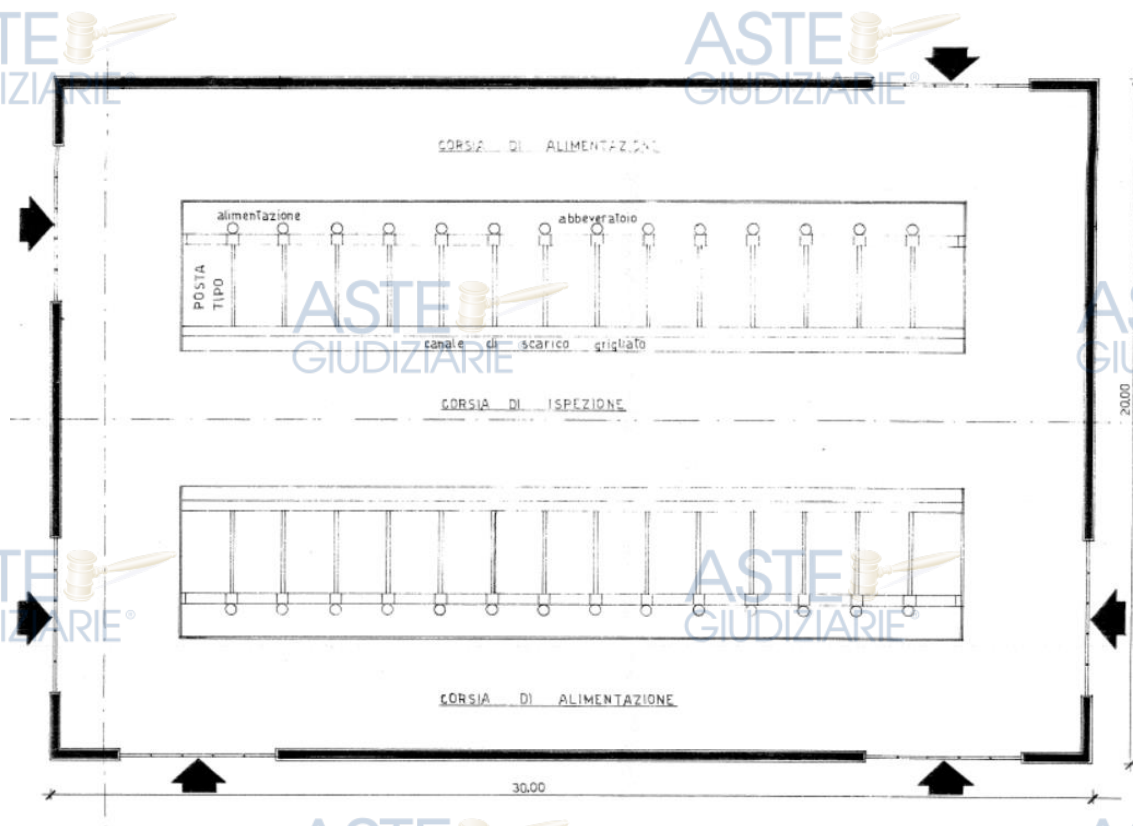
Pianta piano terra C.E. n. 2 del 28.01.1984
